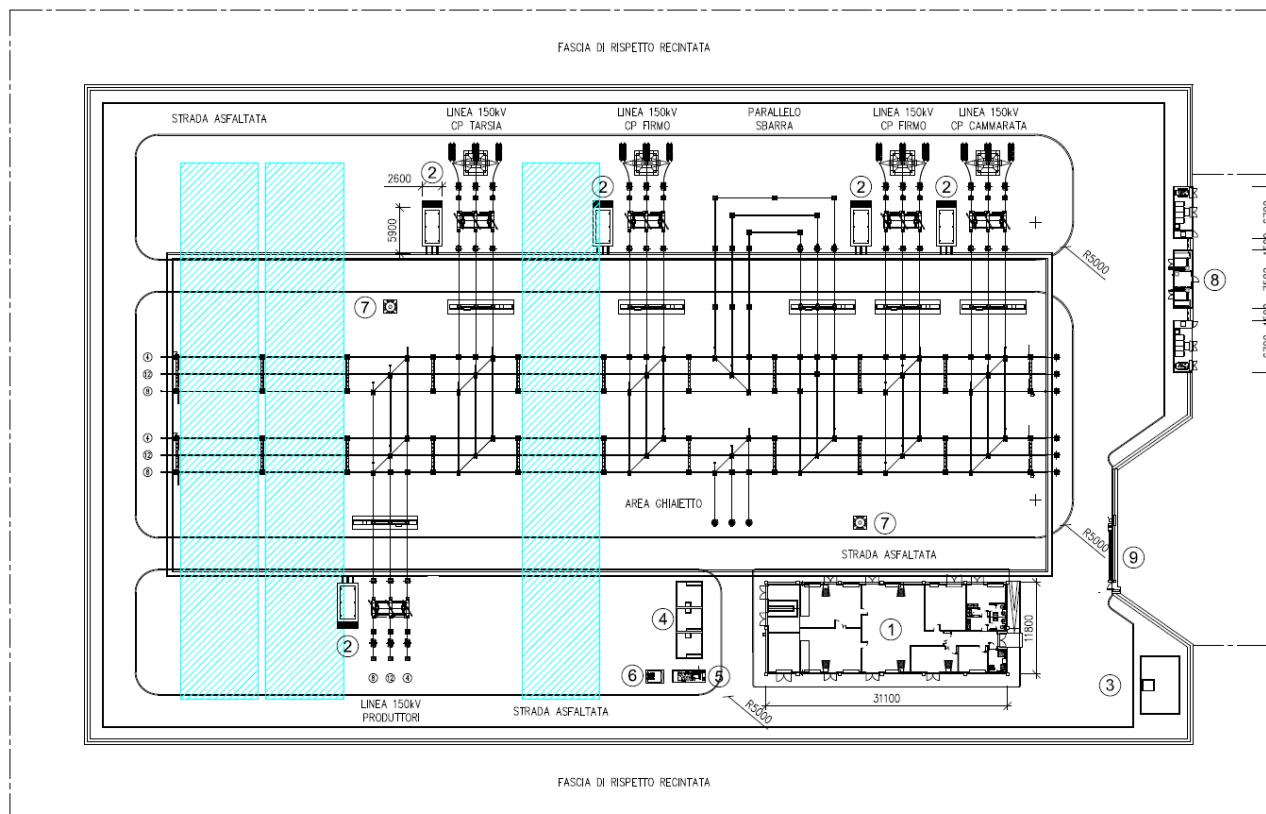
Planimetria SE Cammarata Calabria 150 kV
